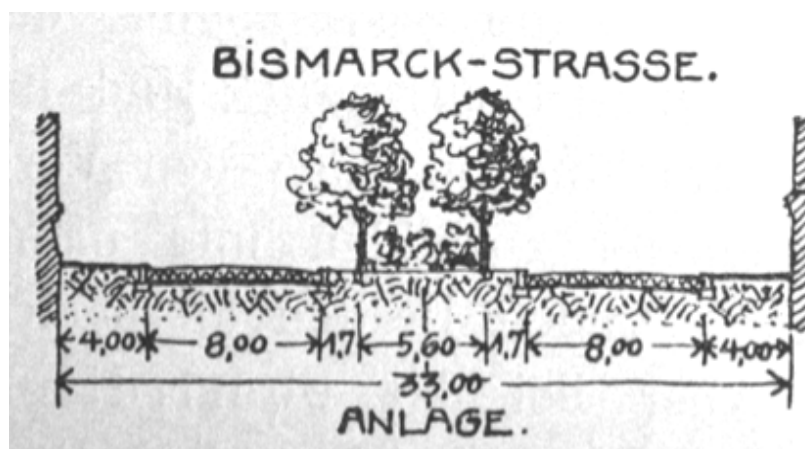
Perfil da Bismarckstrasse, em Berlim, segundo Brix
